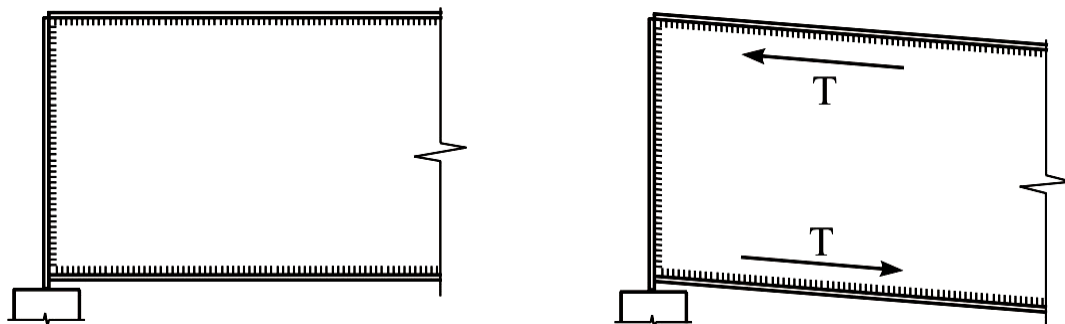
К расчету поясных сварных швов
